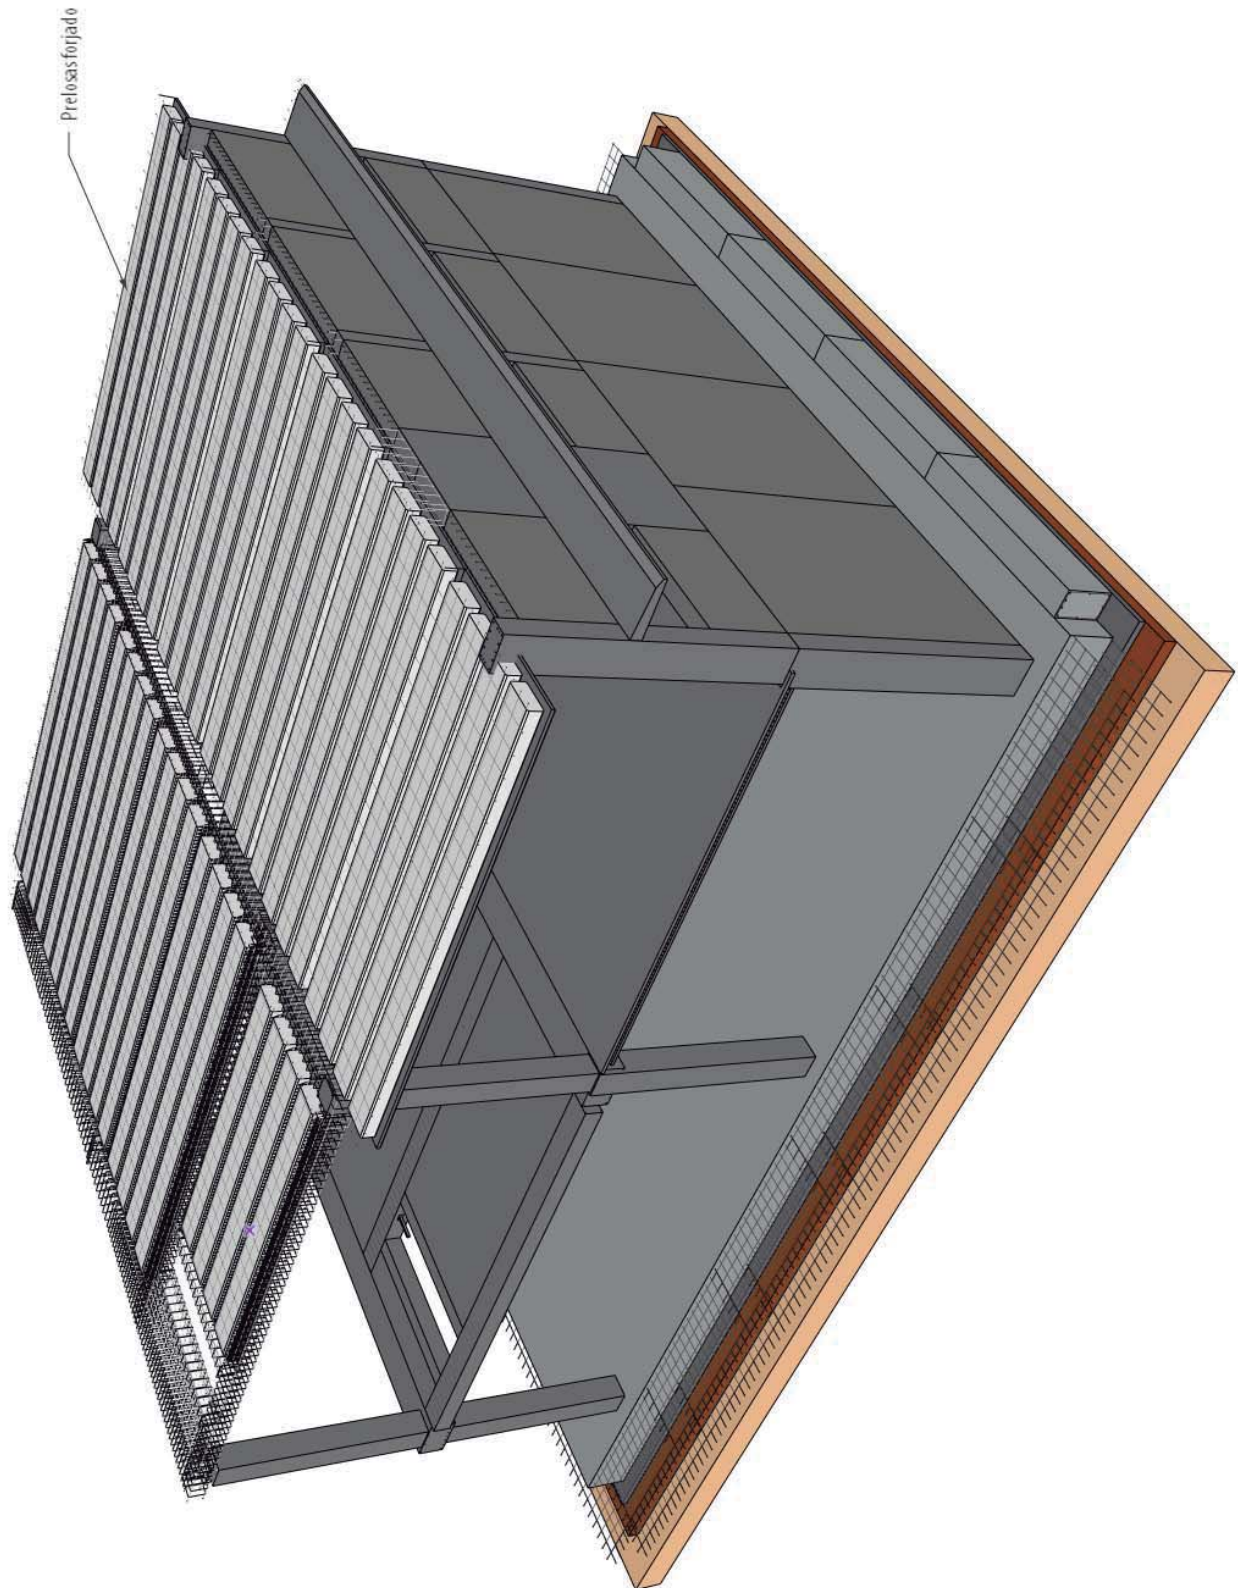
Colocación de las prelosas del forjado de la planta baja
